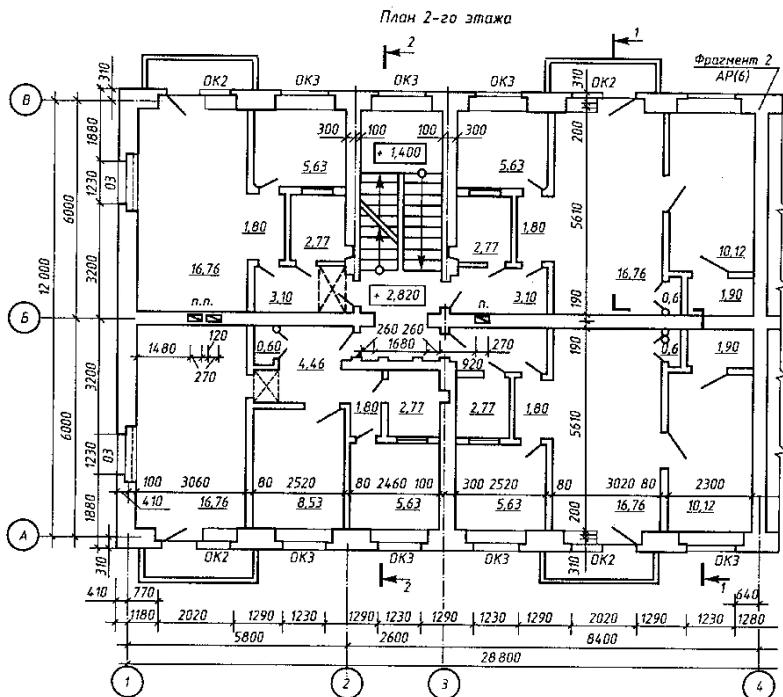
План 2-го этажа многоквартирного жилого дома
